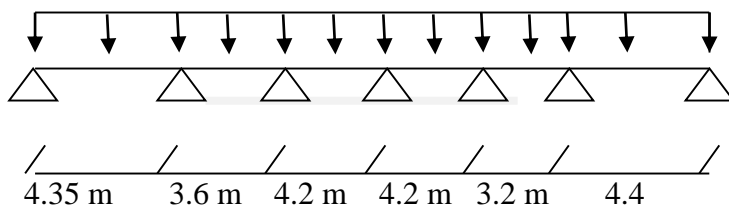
schéma statique de la poutre du 1^{er} cas.
